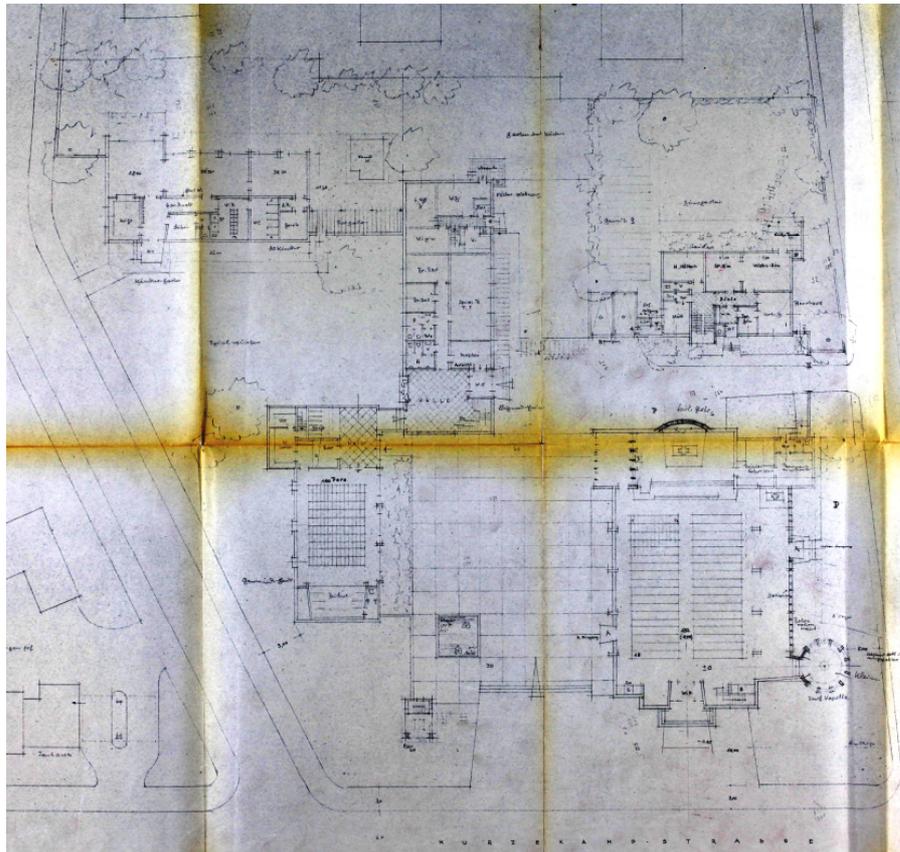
Vorentwurf für den Neubau. Plan 6, Grundriss (Ausschnitt), O. Hodler, undatiert
